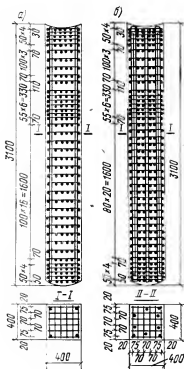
Конструкция колонны с косвенным армированием [21]
